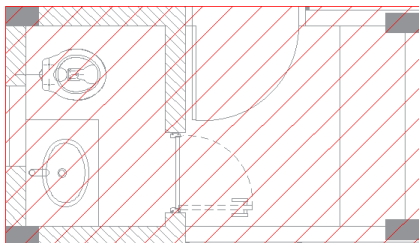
Áreas consideradas para o pavimento em contato com a fundação (Guarita)
